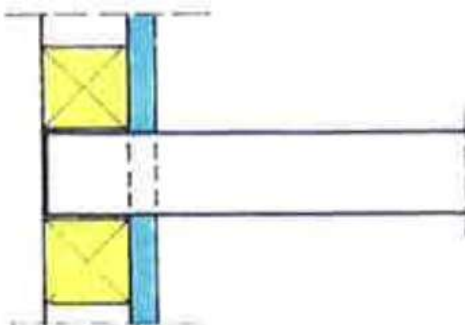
Systemschnitt – Balkenkopf in Fachwerkaußenwand
